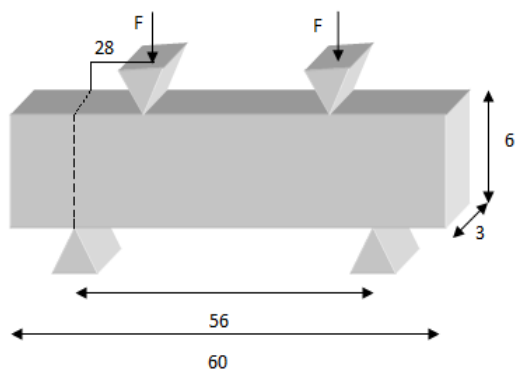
Caractéristiques géométriques de la poutre test 1(poutre sans joint).
